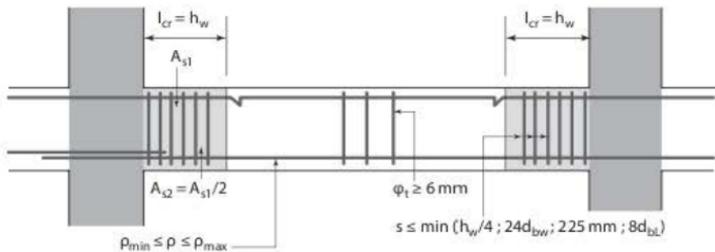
Ferrailage d'une poutre primaire
